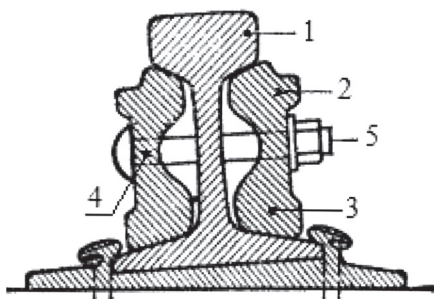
Стандартный рельсовый стык с накладками Р65:
